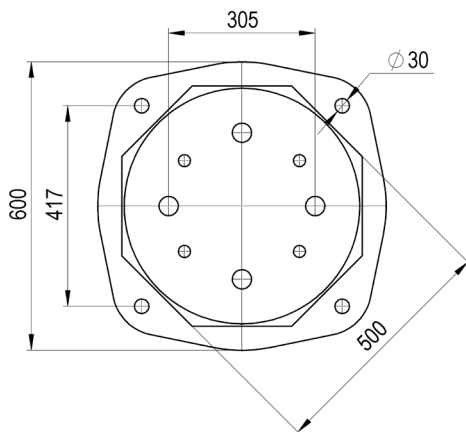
Колодец ККП-1-ССД, вид сверху, габаритные размеры
